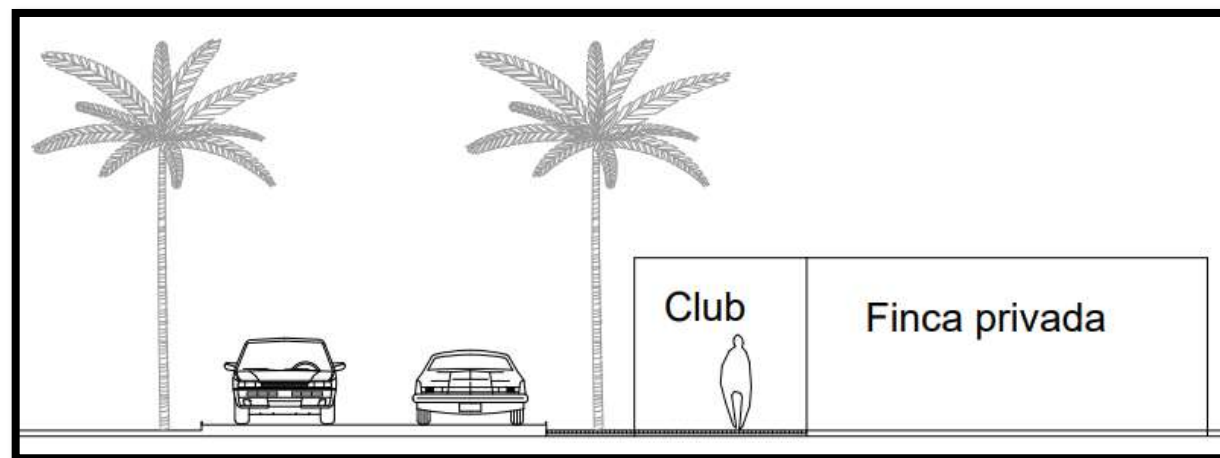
Sección transversal tramo 1. Fuente: Elaboración propia.
